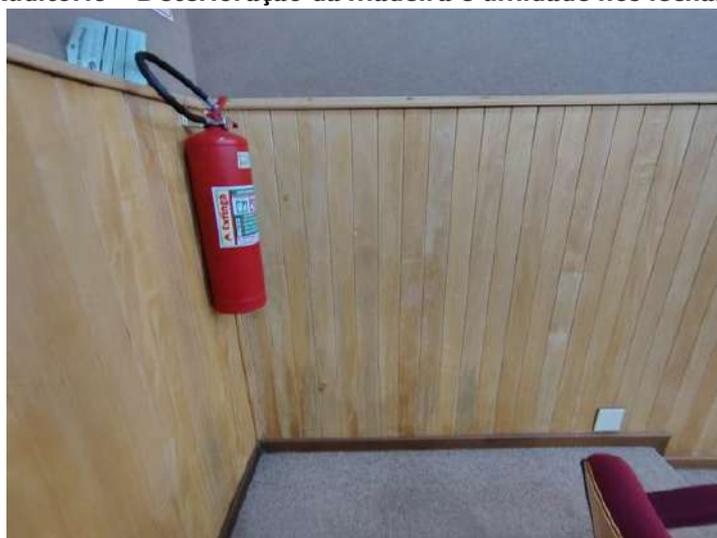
Auditorio – Deterioração da madeira e umidade nos fechamentos laterais
